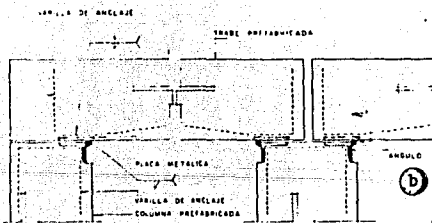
CONEXIONES DE COLUMNAS CON VIGAS
